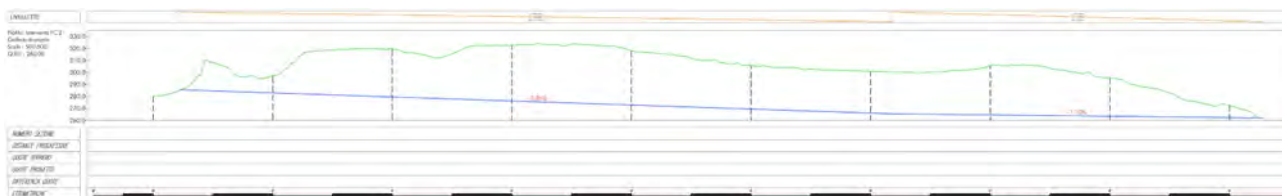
Sezione tipologica del versante in frana con galleria drenante profonda nelle argille.
